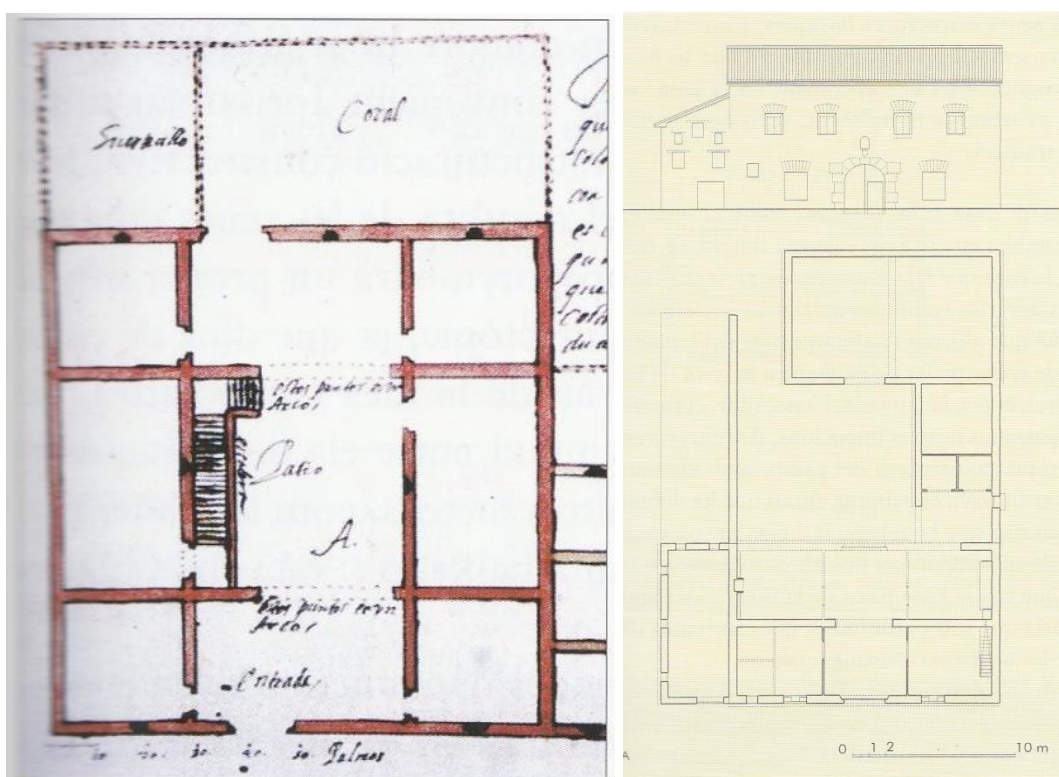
a, casa patio en Villafranqueza, planta de J.B. Antonelli (siglo XVI); b, planta y alzado de la alquería de Pi i Cases de Bàrcena (siglo XVII) (Rey i Aynat, 2010).
